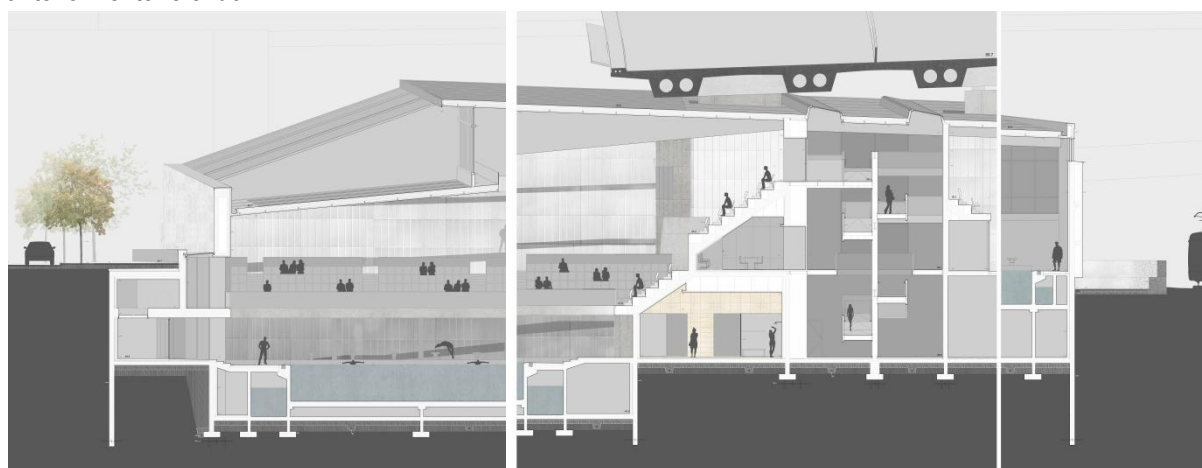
Corte transversal construtivo pelas piscinas, espaços de apoio e acesso vertical em rampa.
